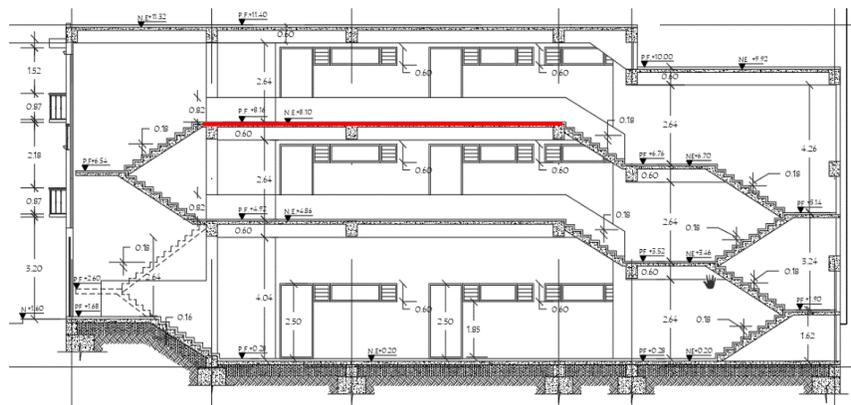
Corte transversal Bloque I, Adaptación de planimetría suministrada por la UGC
